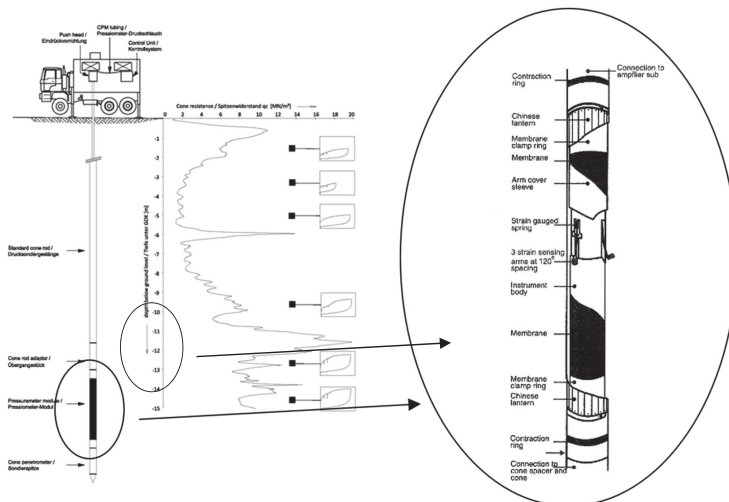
generelles Schema und Detail des FUGRO Drucksondier-Pressiometers
